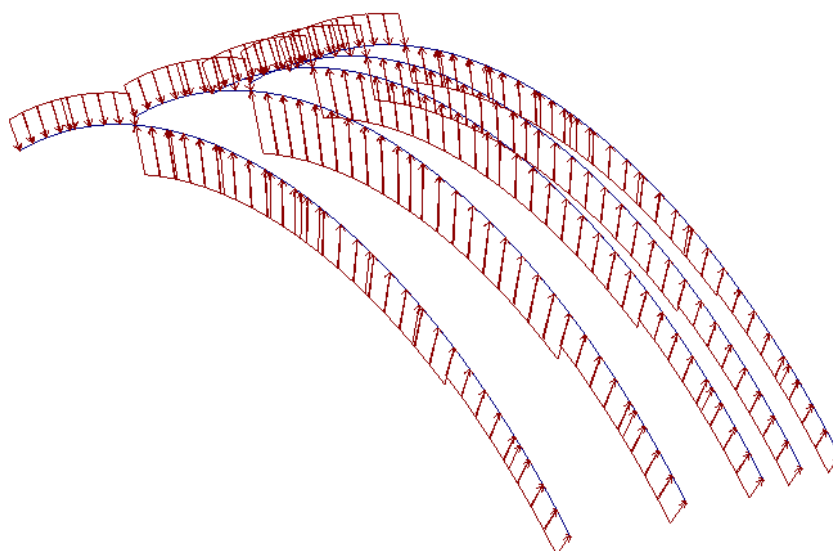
Схема приложения ветровой нагрузки на арочное покрытие блоков Б и В
